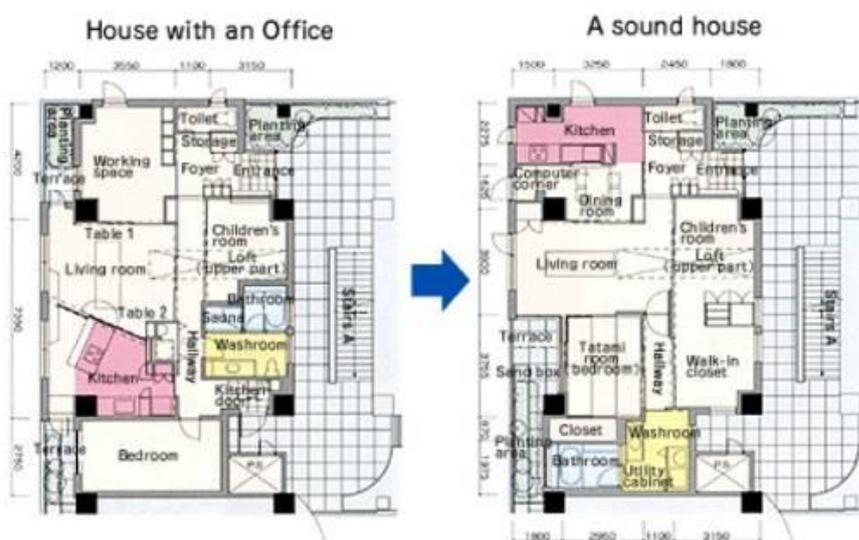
Next 21 – Planta baixa - Duas propostas diferentes de layout (fonte: <https://www.osakagas.co.jp>)
